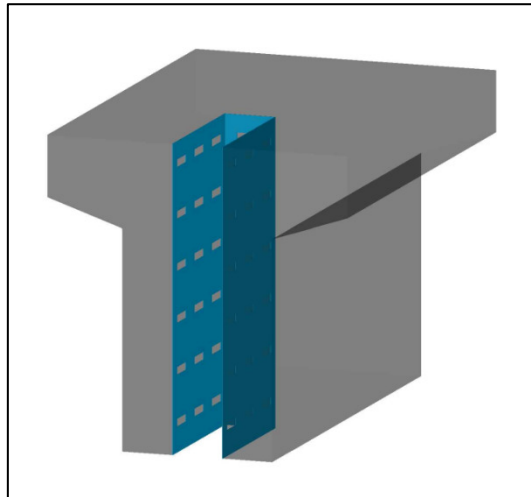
Detalhe do consolo metálico conectado ao pilar.
